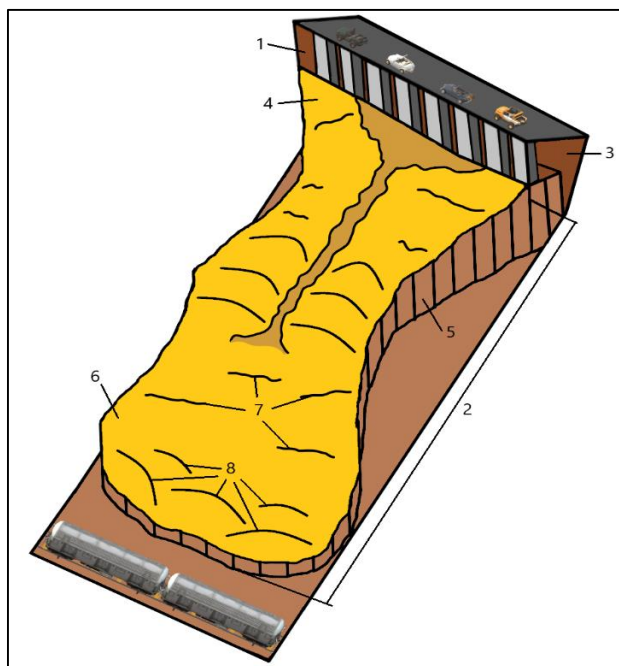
Вид оползня сверху. 1 – часть оползня под дорогой; 2 – поверхность скольжения; 3 – уступ главный; 4 – вершина оползня; 5 – тело оползня; 6 – подошва оползня; 7 – трещины поперечные; 8 – неровности рельефа (фото автора).
